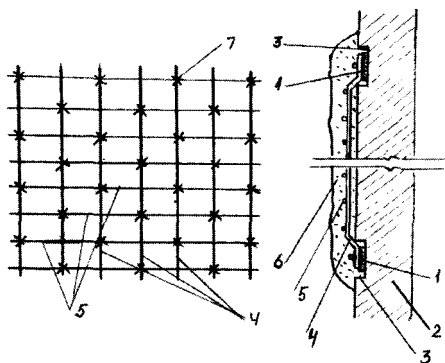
Устройство железобетонной обоймы на стволе кирпичной дымовой трубы:
